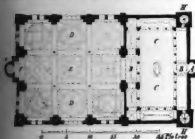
Grundriss einer Moschee in Toledo.
